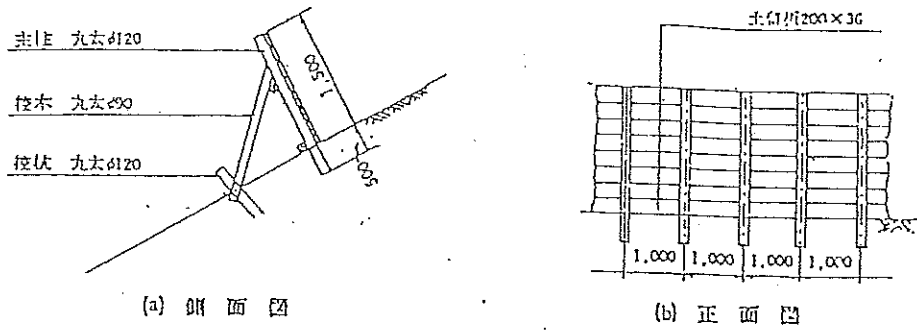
仮設防護柵標準タイプの例 (タイプ①) (単位: mm)
